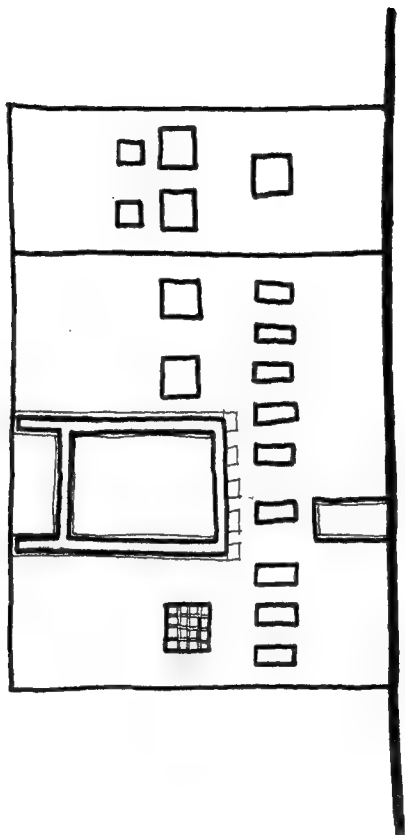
منزل أبو حمام الدور الأرضي المستوى الثاني - مسقط أفقي
